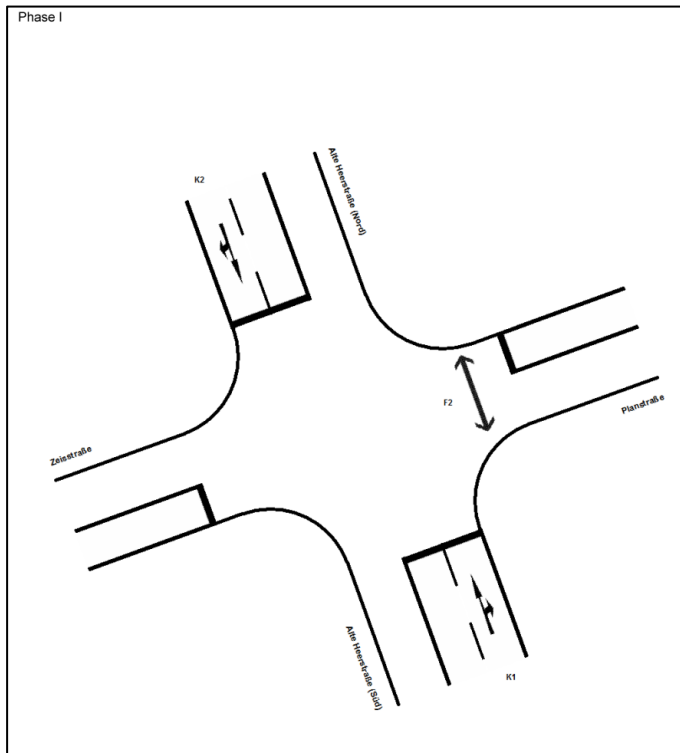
Phase 1 am Knotenpunkt Alte Heerstraße (B3) / Zeissstraße / Planstraße
